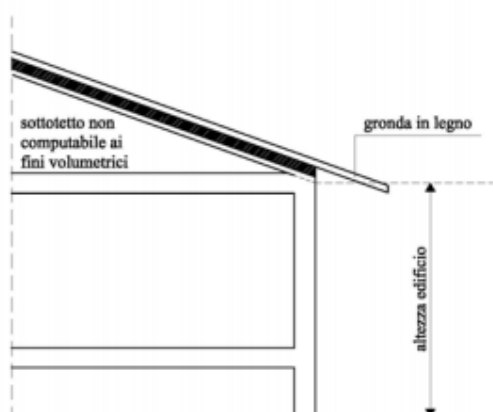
Edificio con dislivello inferiore a 60 cm con tetto ventilato e gronda inclinata
